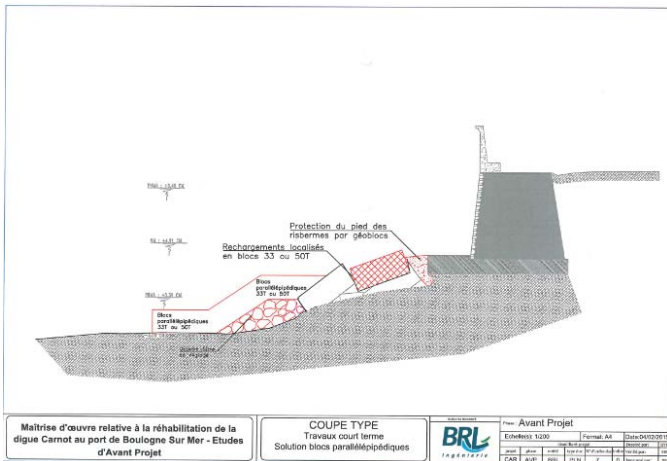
COUPE DE PRINCIPE DES TRAVAUX COURT TERME - SOURCE : BRL INGENIERIE
